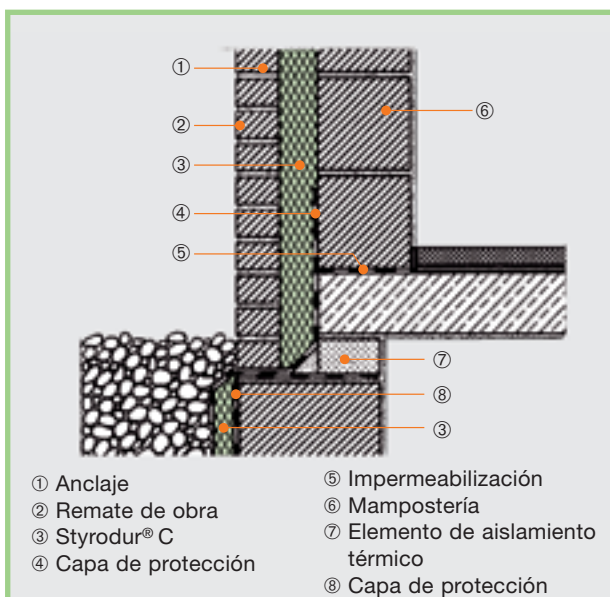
Conexión del aislamiento perimetral en trabajos de mampostería con aislamiento central.
